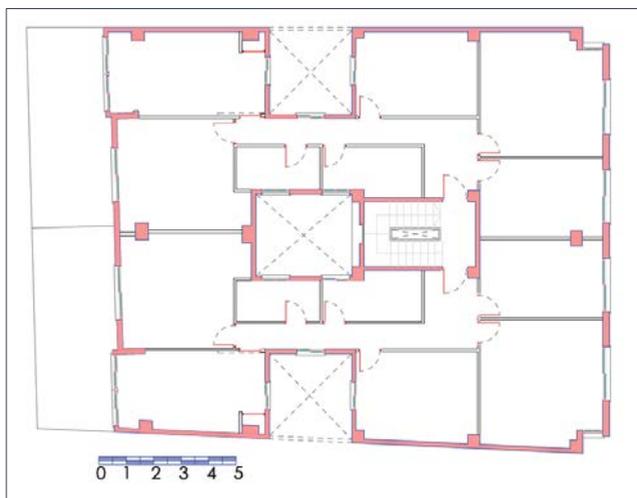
San Rafael, 21. Planta tipo estado actual.
